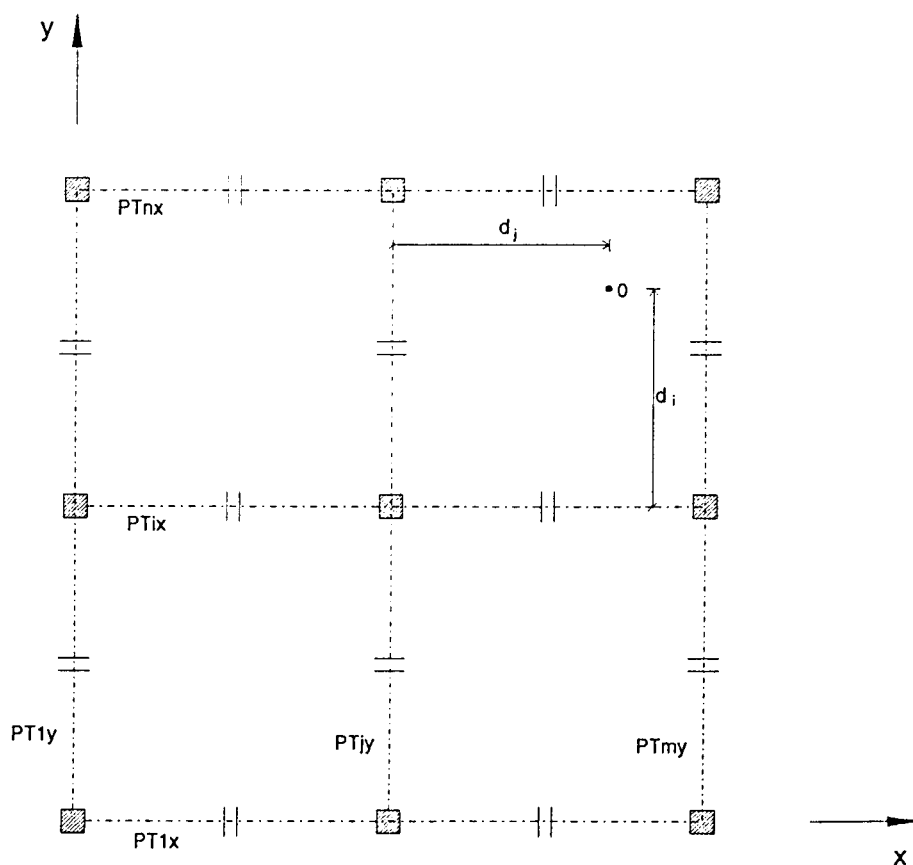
Estrutura tridimensional genérica - Distribuição em planta dos elementos planos resistentes.
